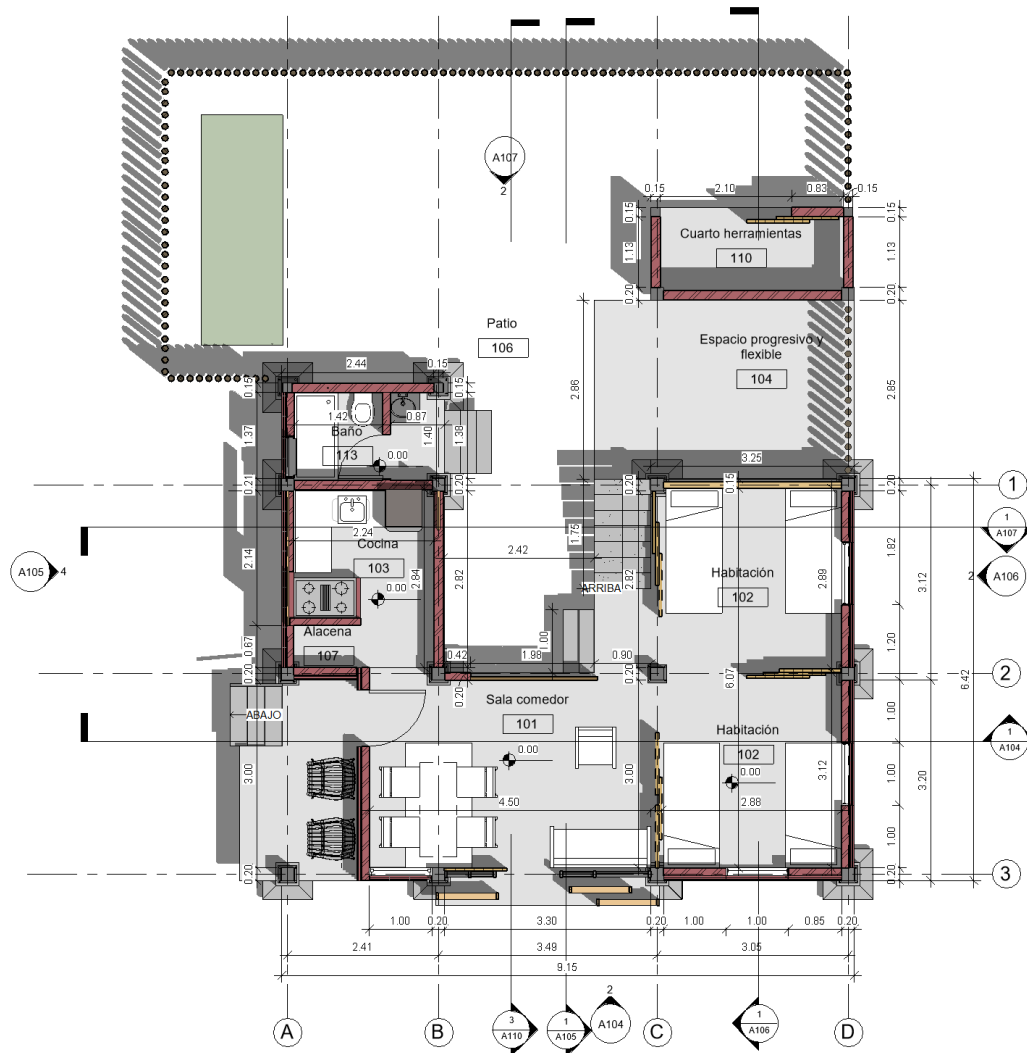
Planta de primer nivel de la vivienda -Etapa 1
